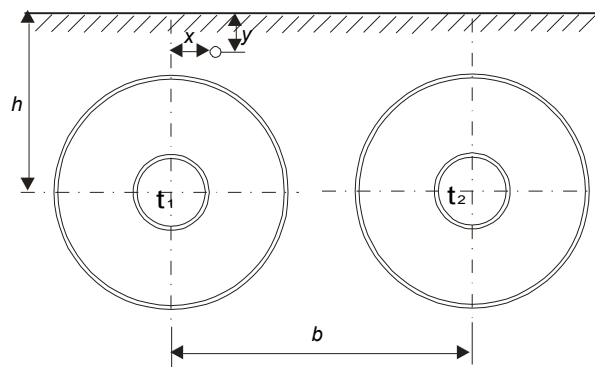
Схема двухтрубного бесканального теплопровода
